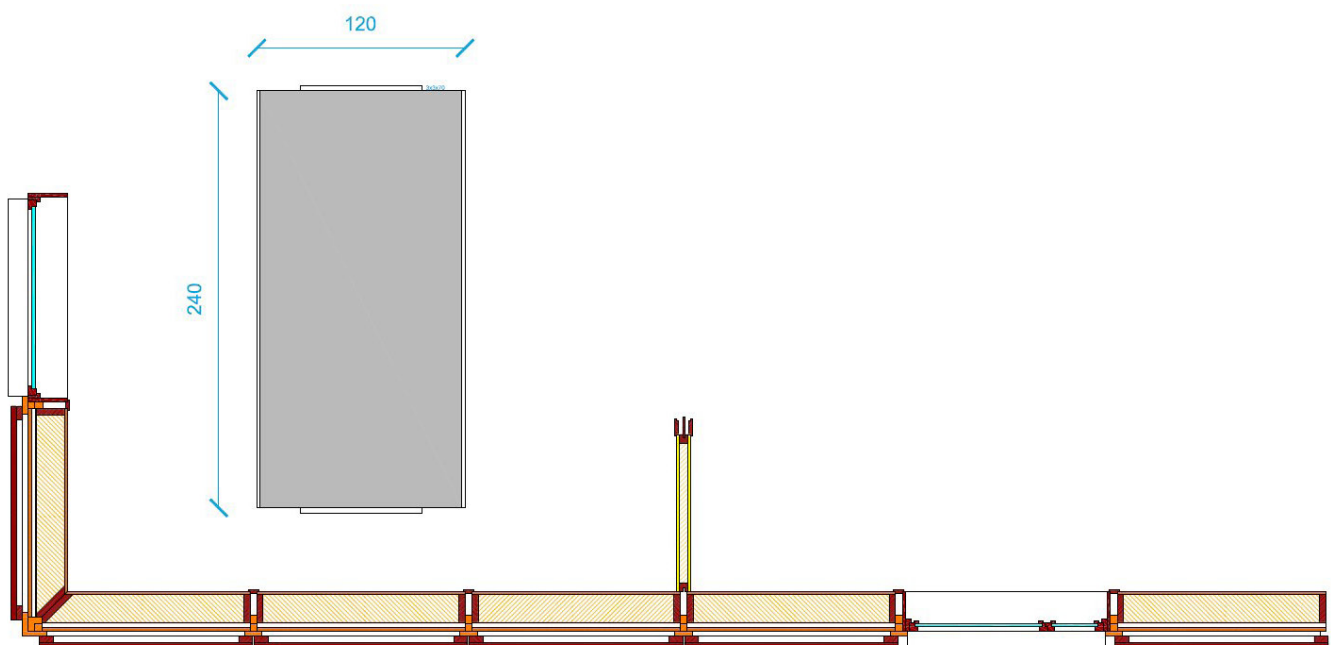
Composición de módulos de fachada. Definición geométrica en alzado y despiece en planta.
